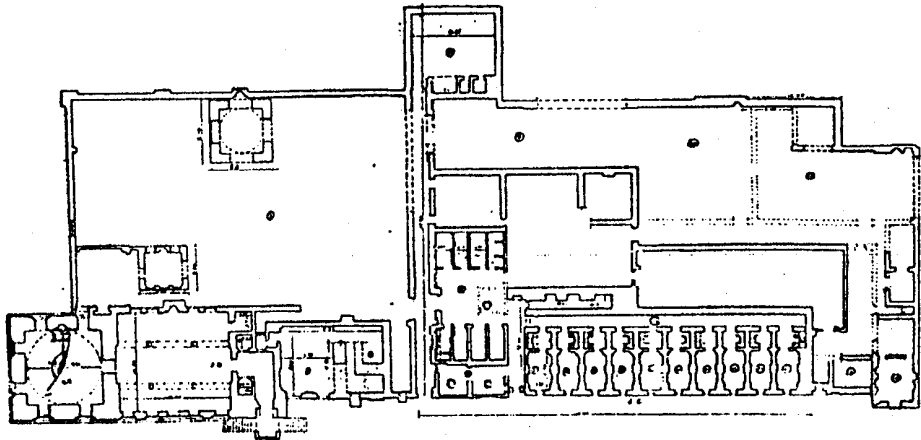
مسقط أفقي لخانقاة السلطان برسباي ضمن مجمعة
